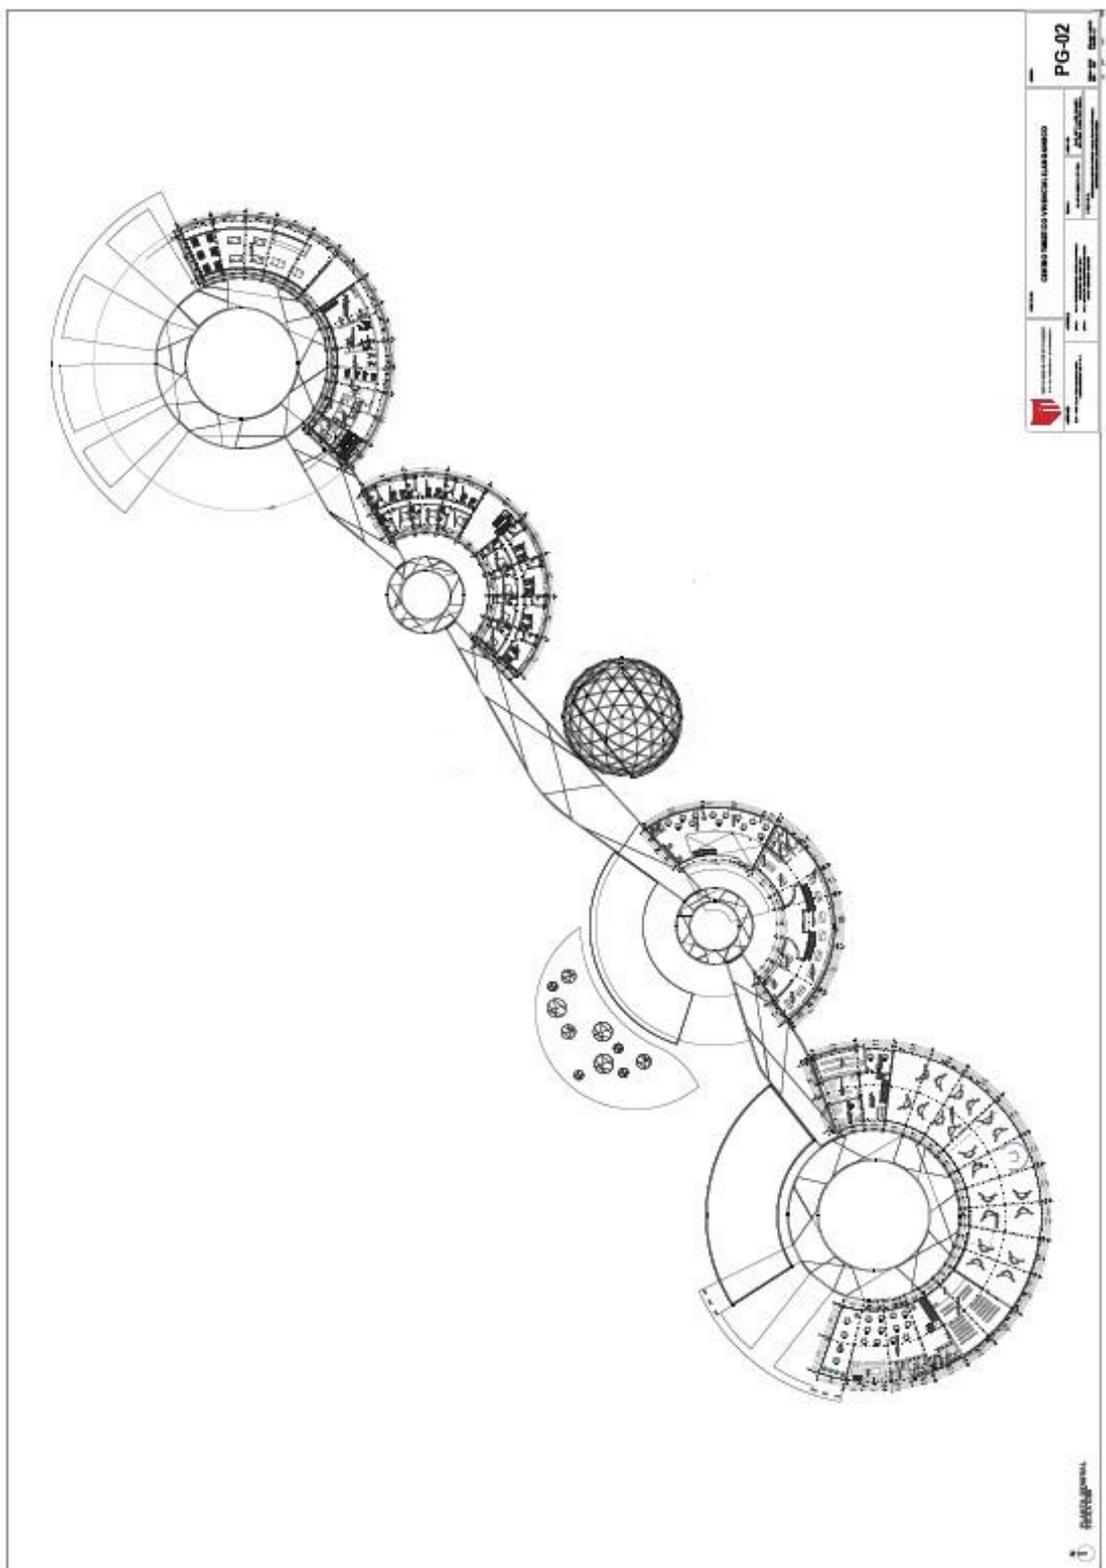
Planos Generales (segundo piso). fuente: elaboración propia
